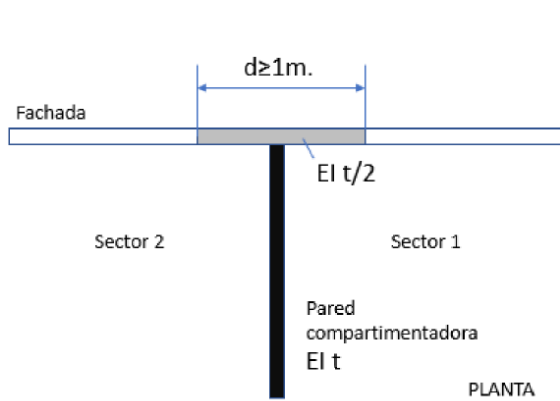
Compartimentación entre dos sectores con fachada plana ($\alpha=180^\circ$)
